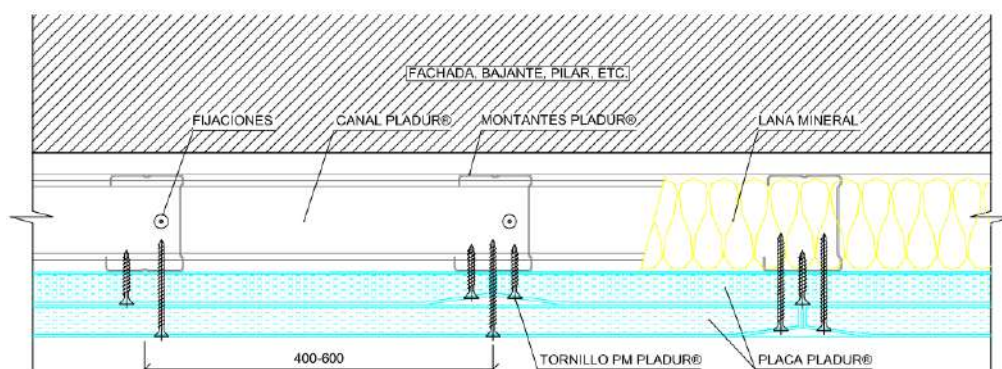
Esquema detalle tipología trasdosado autoportante yeso laminado". Fuente www.placo.es
